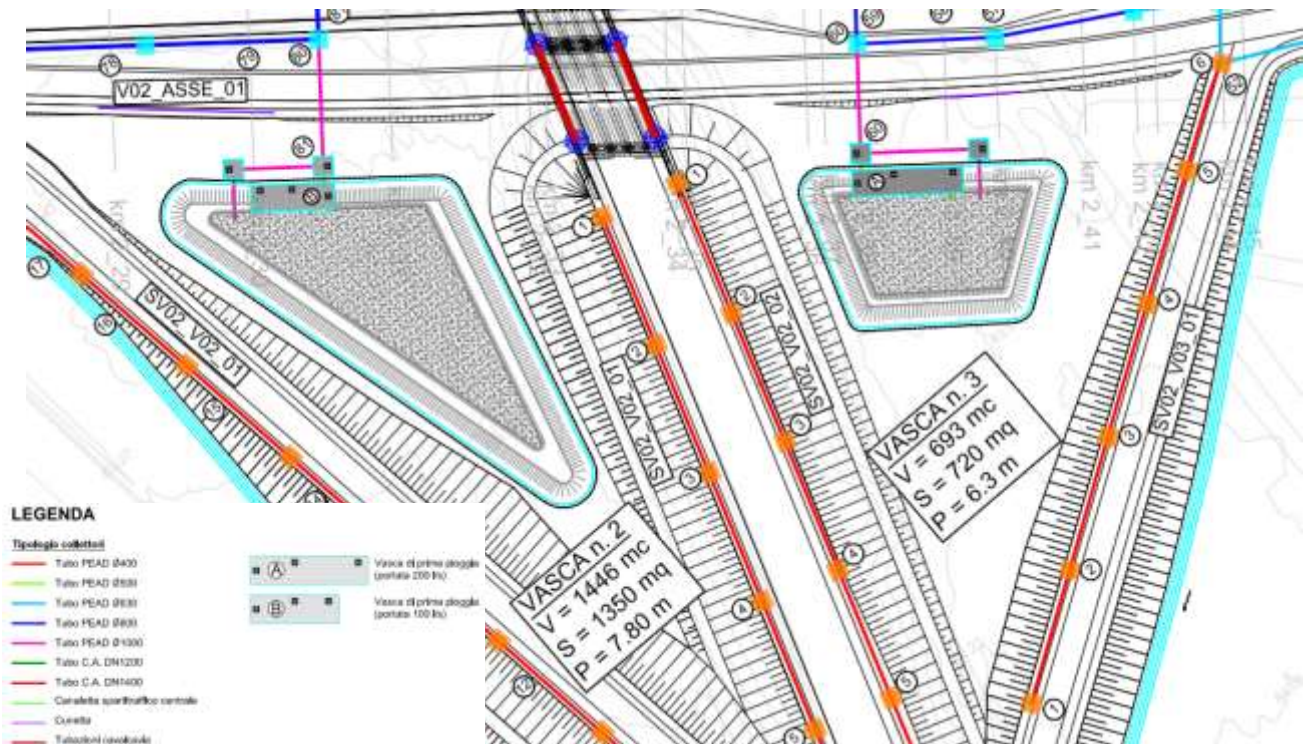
Pianta della vasca di trattamento n.2 e 3
